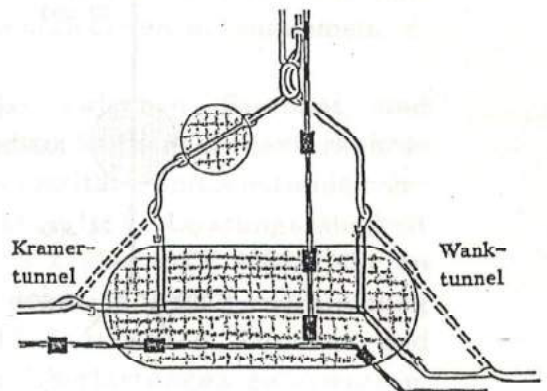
Nach Fertigstellung von Kramertunnel und Wanktunnel
